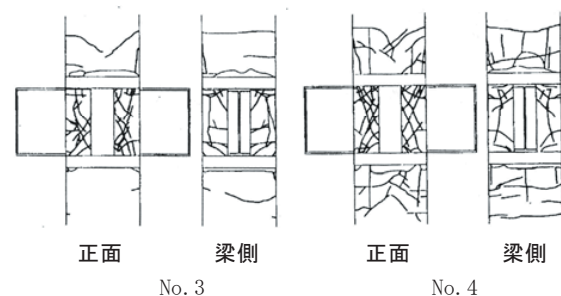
ひび割れ状況(シリーズ1 No.3, 4 試験体)
